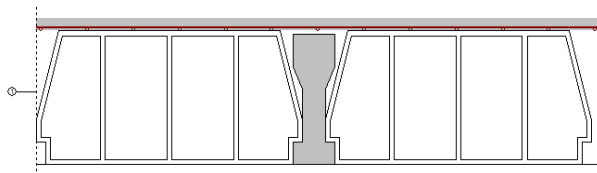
Detalle constructivo de Forjado. Fuente: CypeCad Mep
